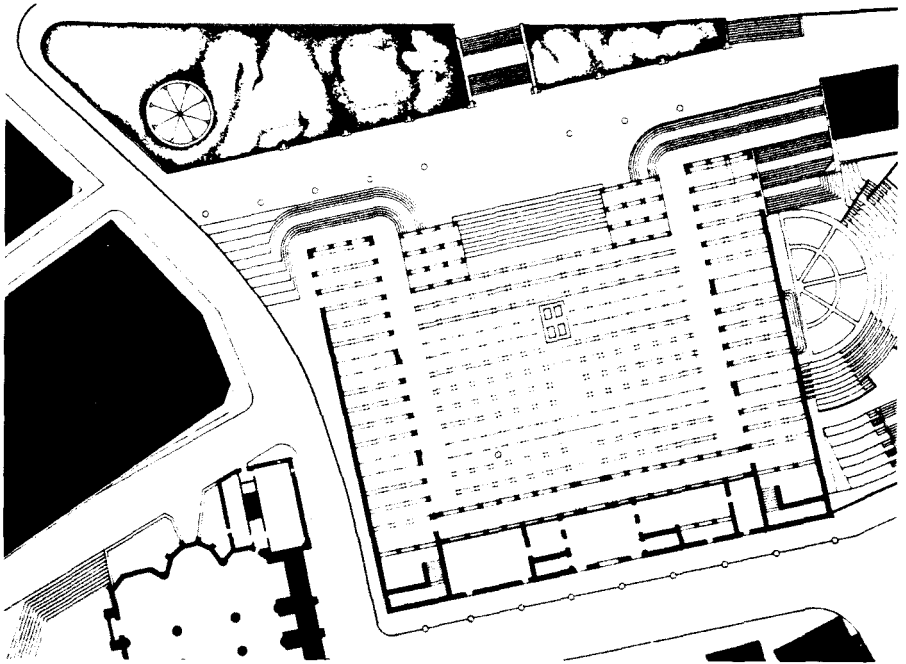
Proyecto de Miguel Garay. Plano de la planta baja al nivel de la plaza.
